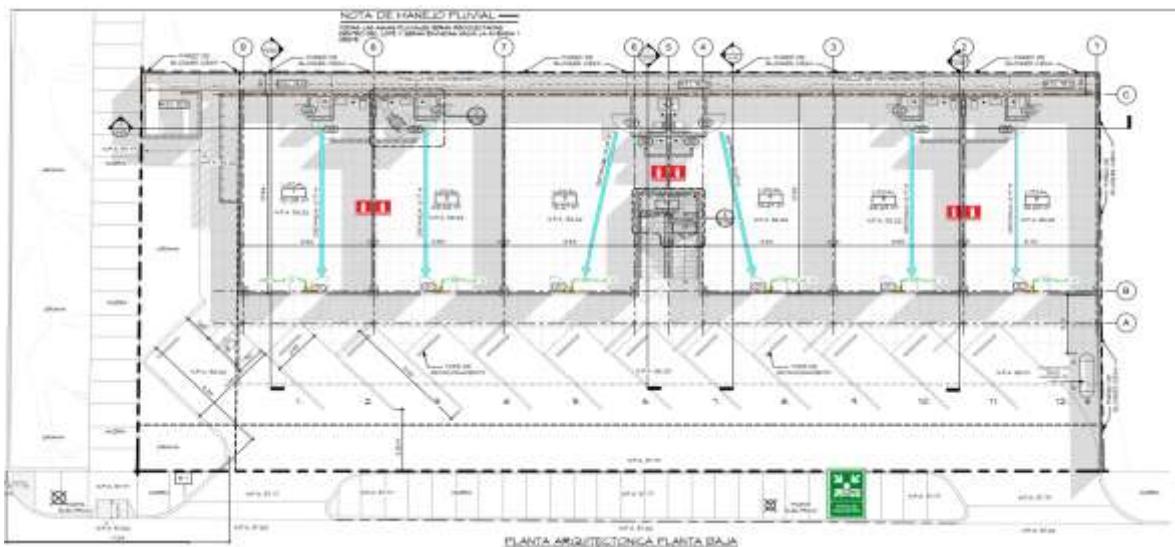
Planta arquitectónica PLANTA BAJA. Fuente: Plano del proyecto
